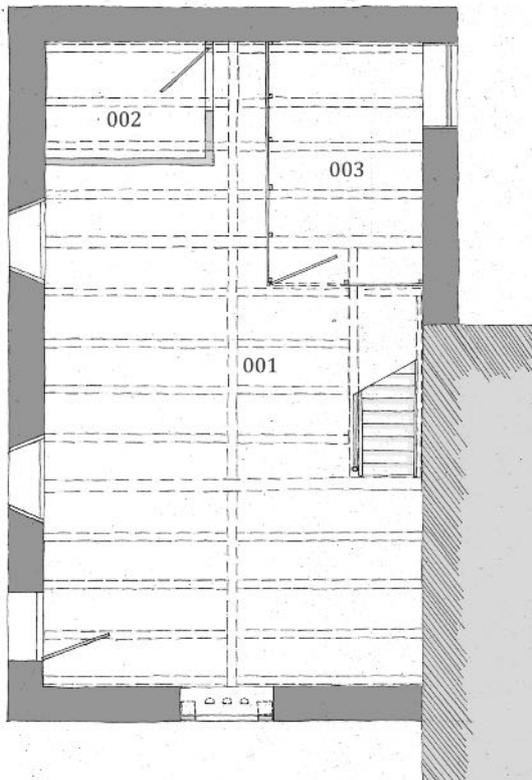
Grundriss Wachturm (EG), M 1:100
